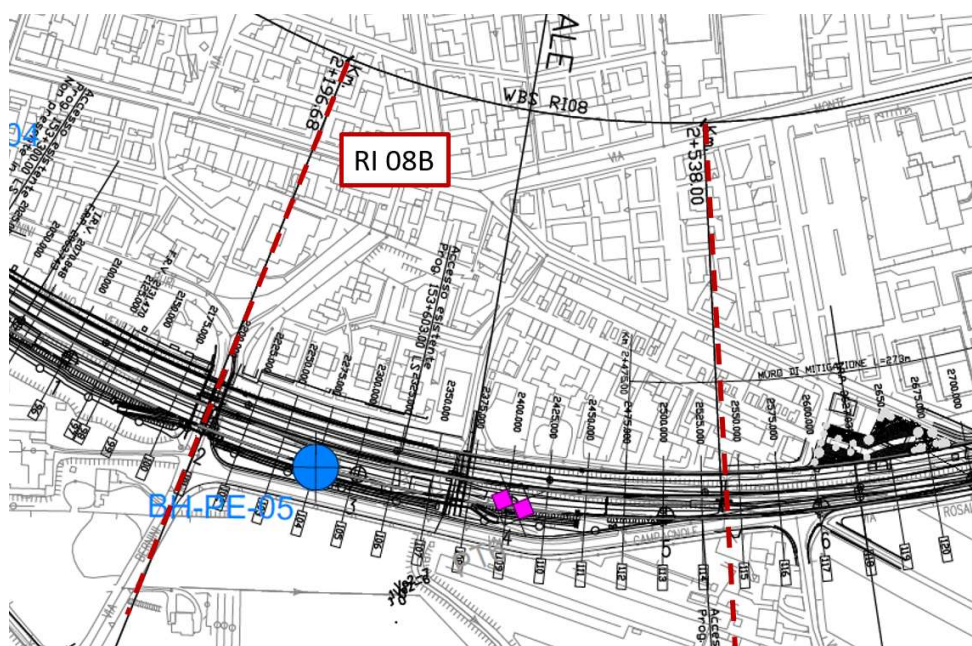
Planimetria Rilevato RI08B, estratto dalla Planimetria Generale (Doc. Rif. [3])
